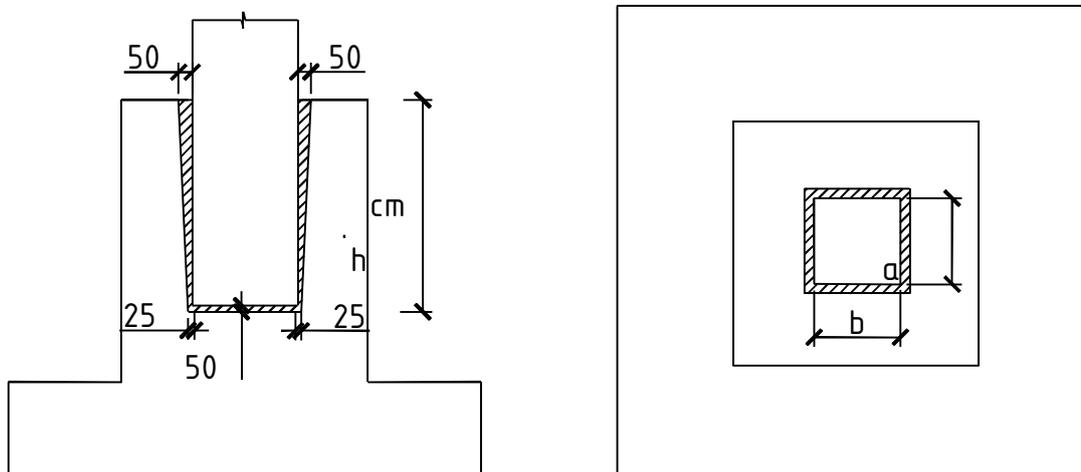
Схема стыка колонны и стакана фундамента, к определению объема заделки стыков колонн с фундаментами
